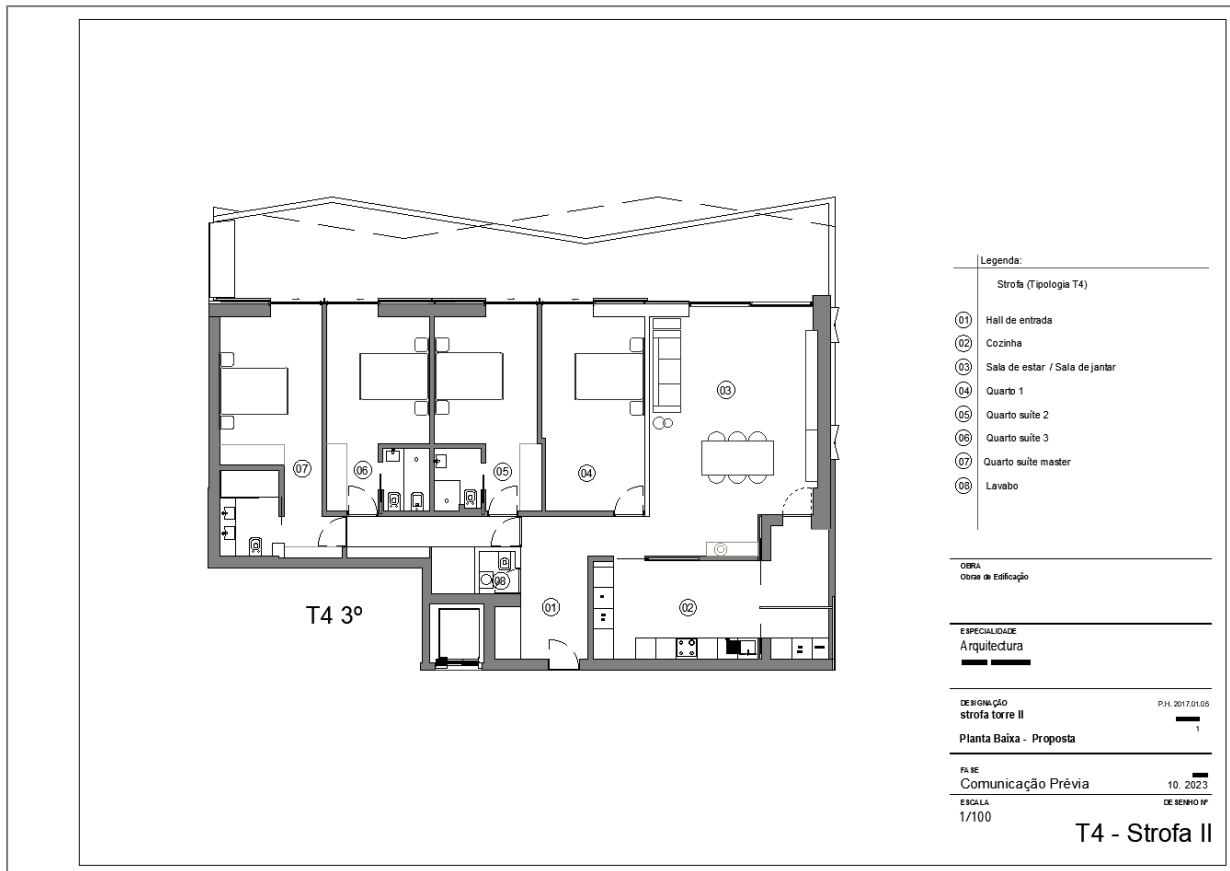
Planta baixa cedida pela construtora - Projeto AG. Fonte: Acervo FBN.
